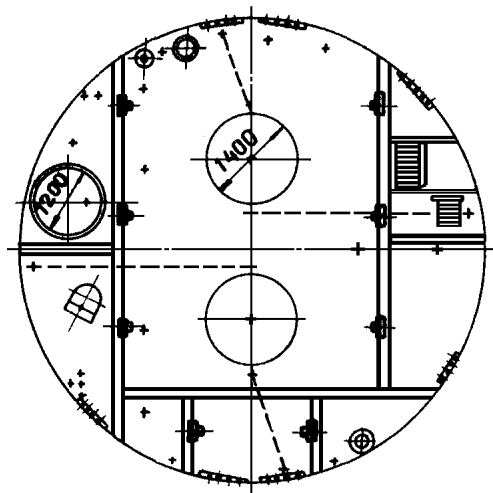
Схема расположения оборудования в клетевом стволе на период его армирования
